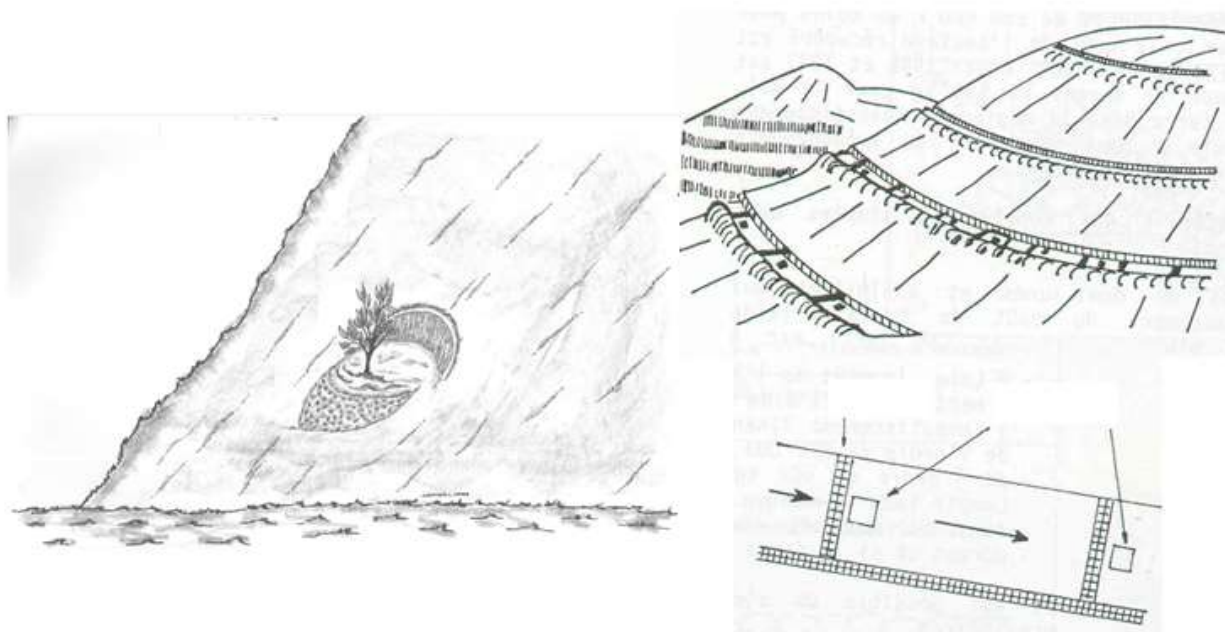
Esquema de uma banquetta individual e de patamares construídos para instalação de banquetas.
